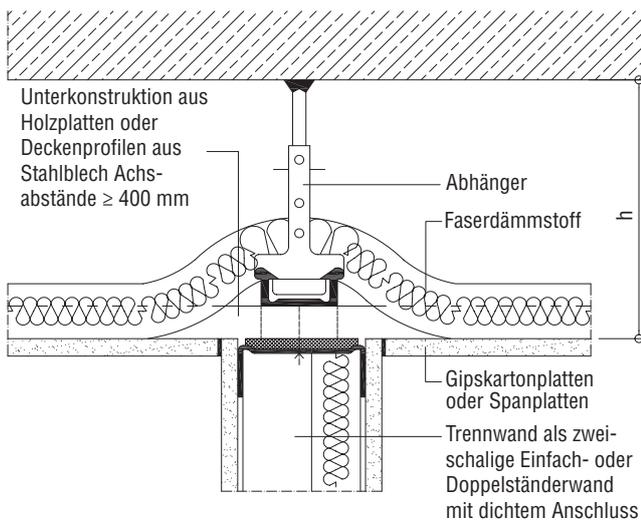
Trennwandanschluss an Unterdecke mit Trennung der Decklage
